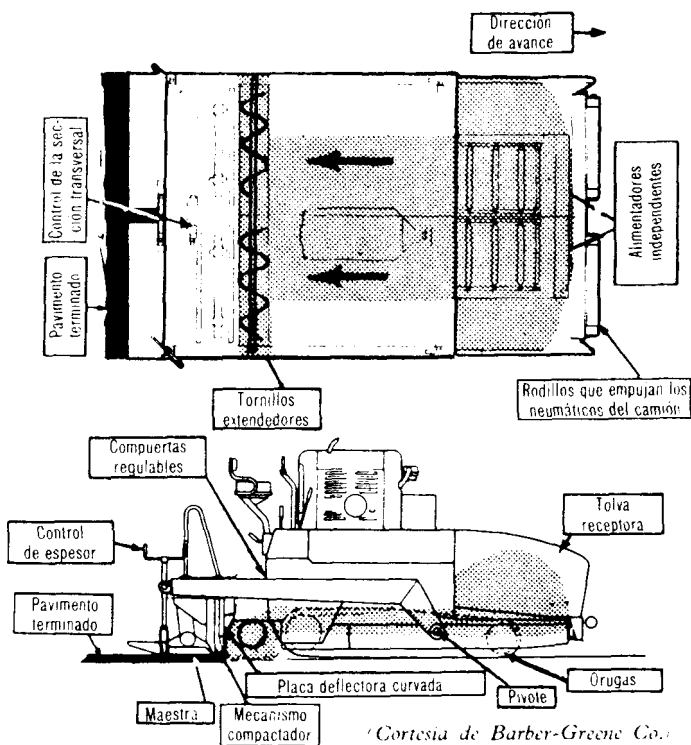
Esquema de una laminadora para pavimentos asfálticos.
